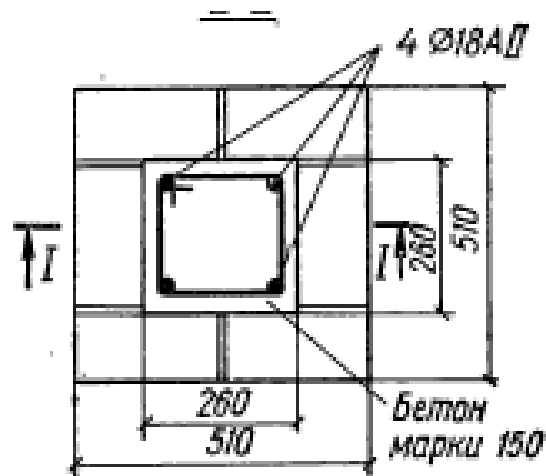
Армирование столба комплексной конструкции (к примеру 39).
